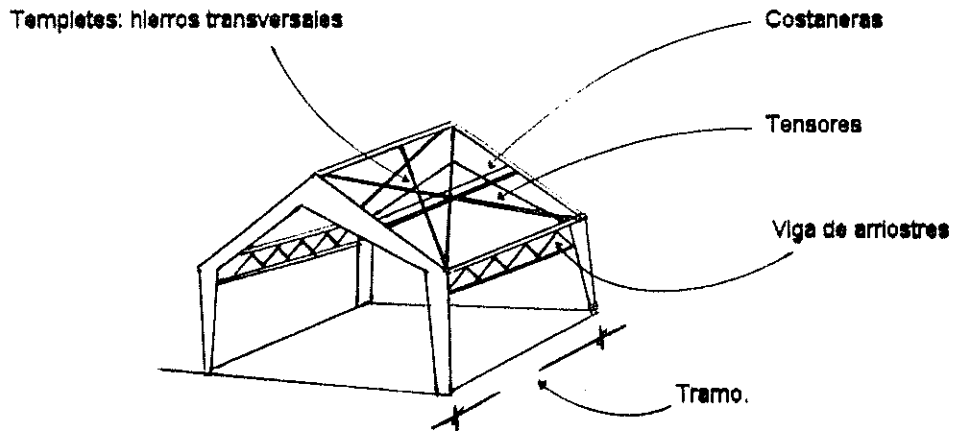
(Distribución de tensores en una estructura liviana)
